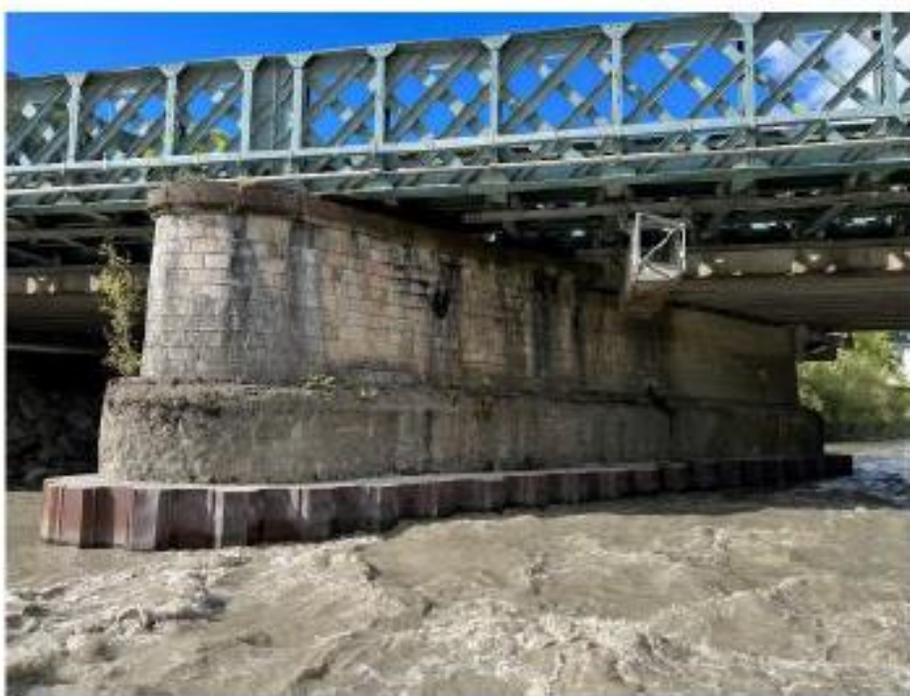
Photographie de la pile centrale P1 et du pont-rail ferroviaire (Source : SNCF)
